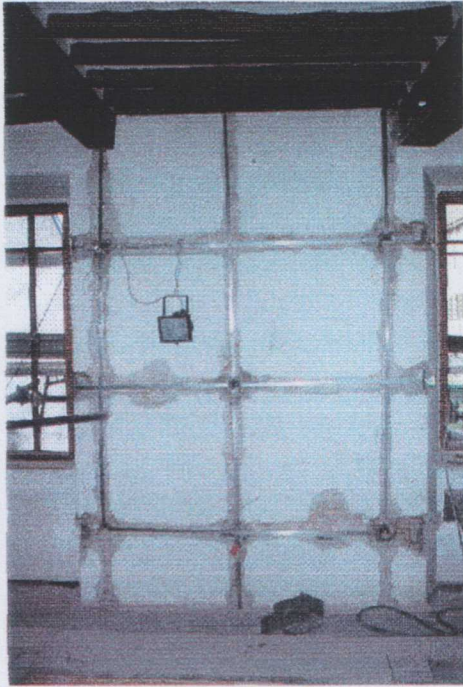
si apprezza la posa lungo le tracce d'intonaco con continuità verticale del collegamento.
